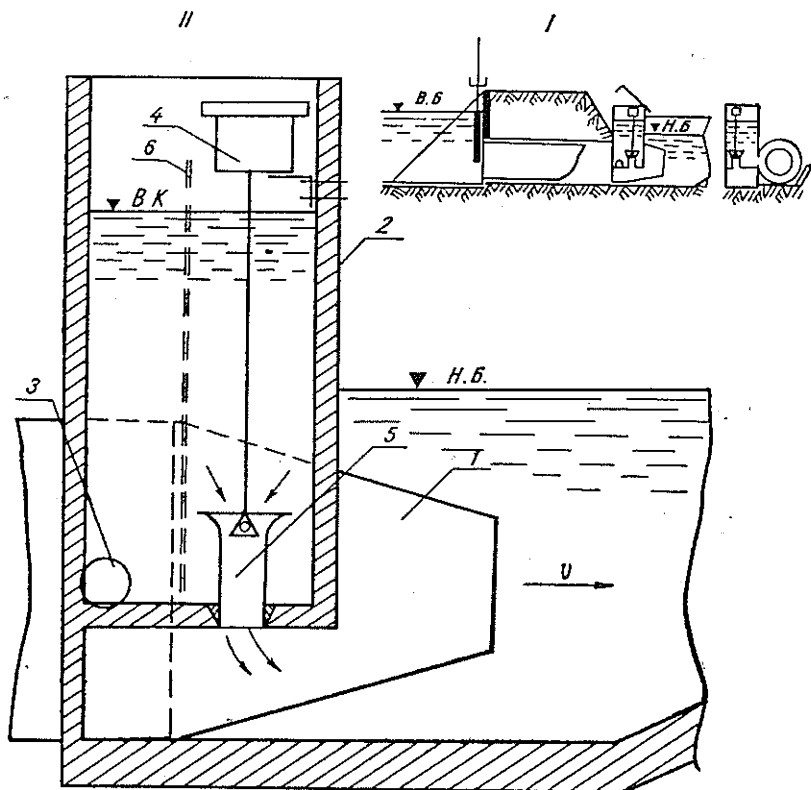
Схема монтажа ДРС-60 на трубчатом водомере-регуляторе с насадком.
